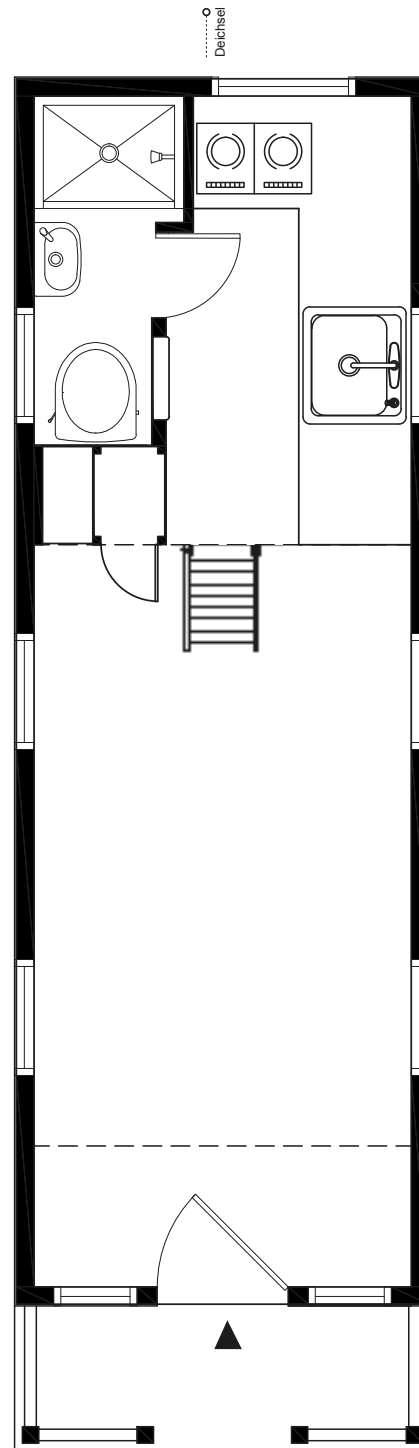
+ 26: adaptierte Grundrisse „Elm“<sup>55</sup>
